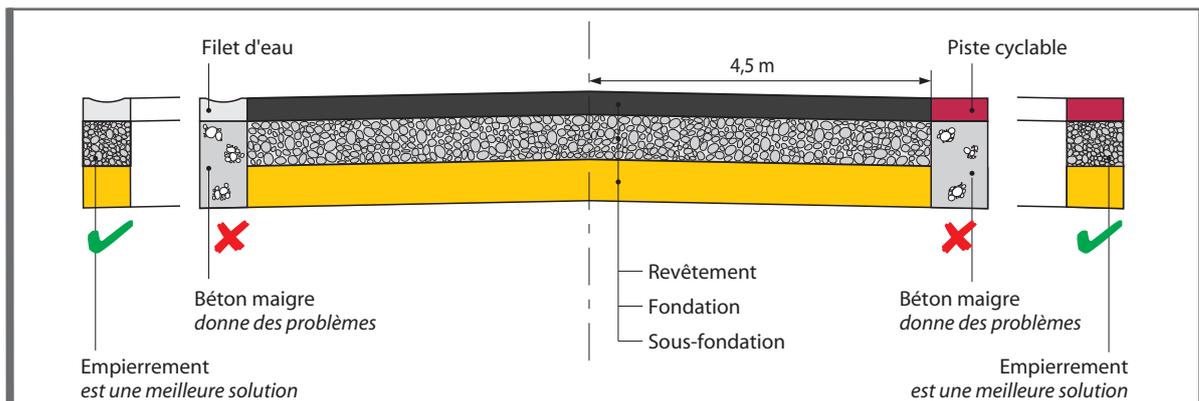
Exemple de structure routière avec placement ultérieur fautif de filets d'eau et d'une piste cyclable sur une fondation en béton maigre
